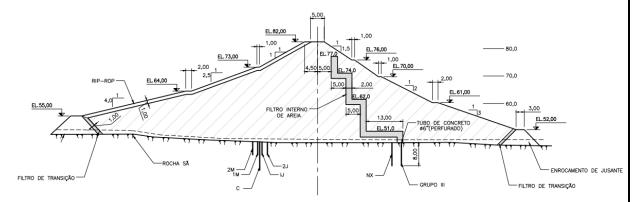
Seção transversal da barragem Fonte: Adaptado de Geotecnica, 1960.
